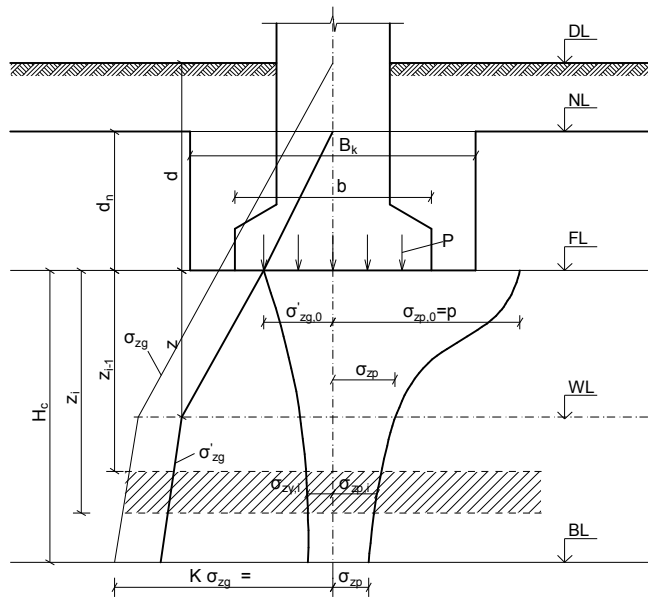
Епюри напружень під подошвою фундаменту за методом пошарового підсумовування
